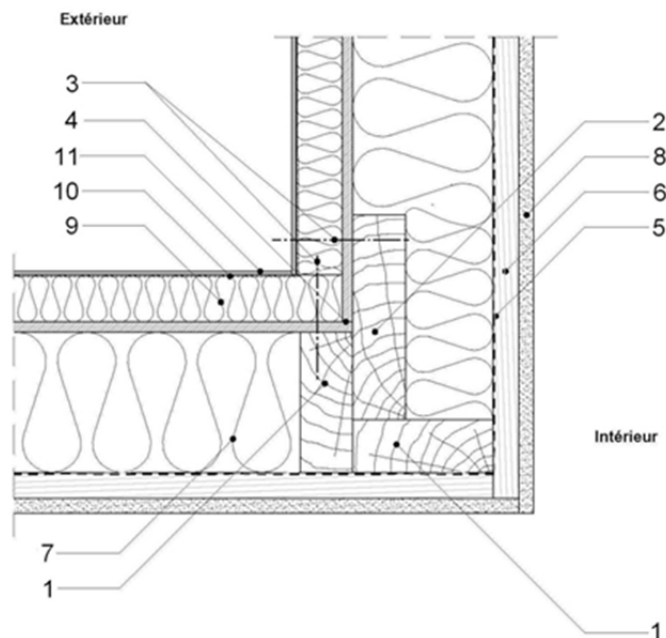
Fixations mécaniques aux angles rentrants (coupe horizontale)
